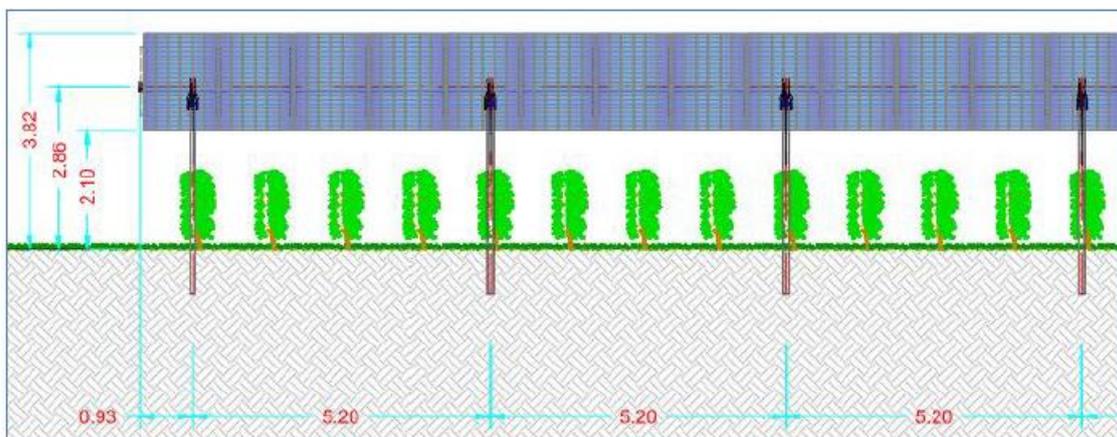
Sezione longitudinale tipologica struttura Tracker con vigneto
